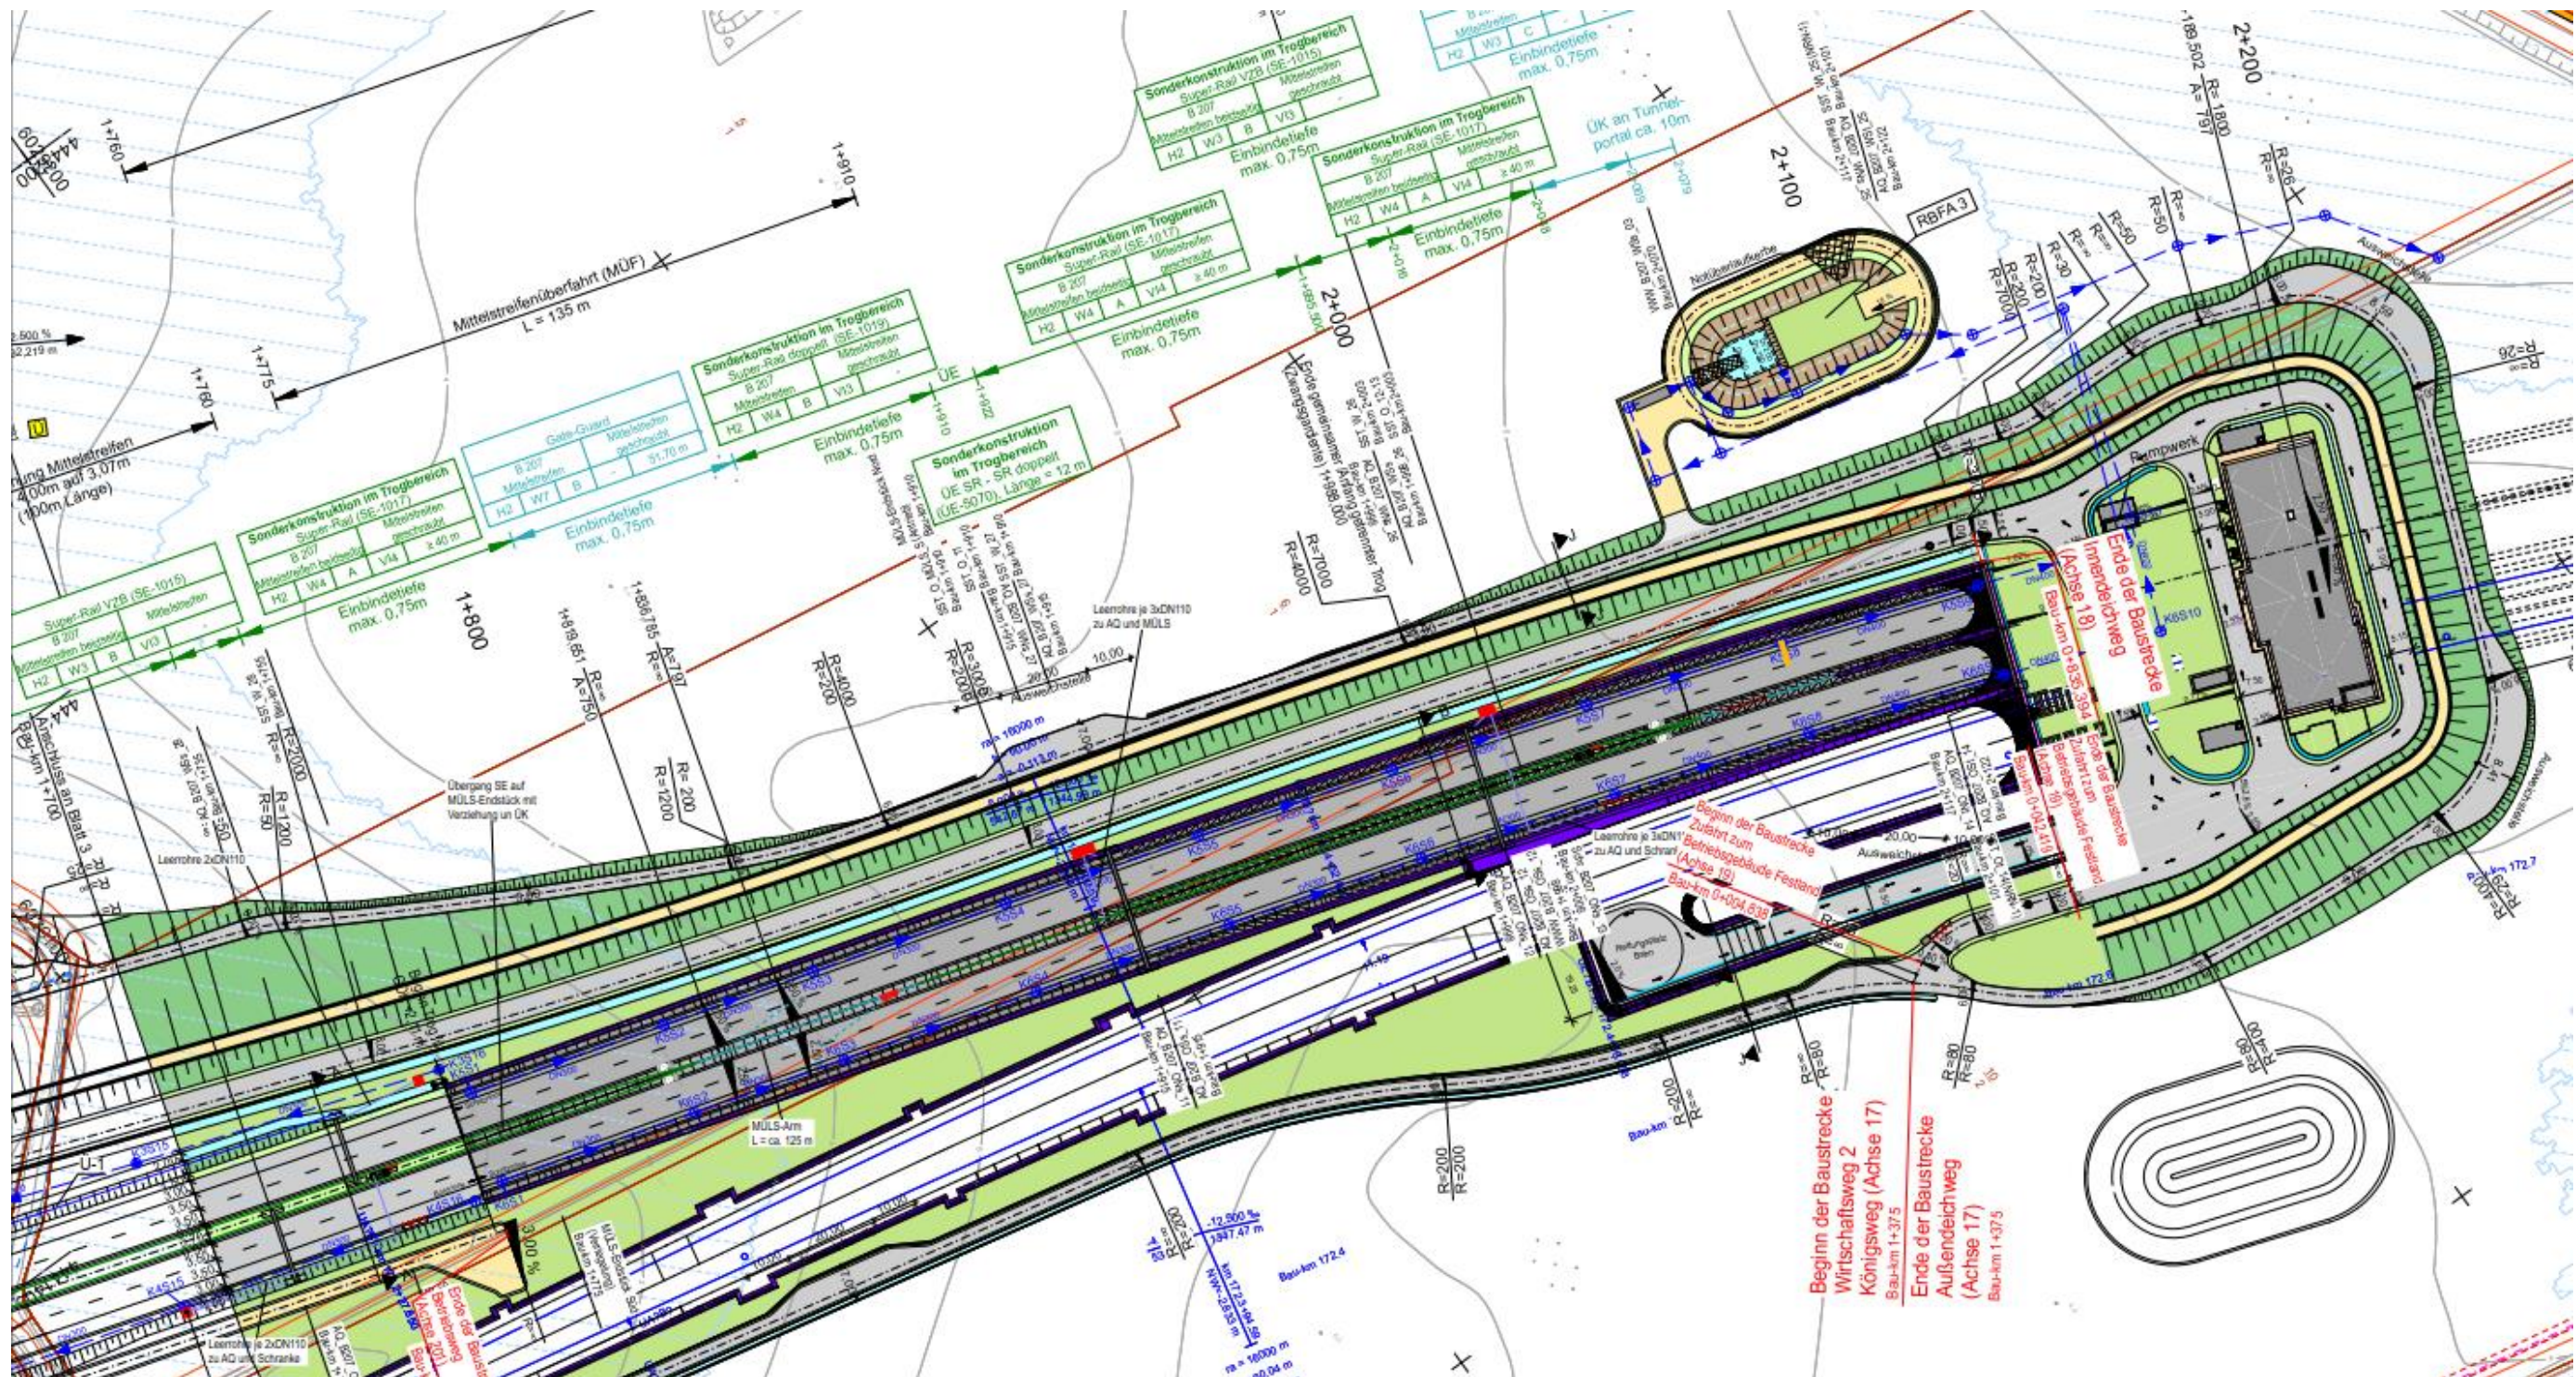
Ausschnitt Lageplan 4.1 Süd Streckenplanung, Stand 13.06.2023 (siehe FBQ_FSQ_0207_99999_VA_2DF_3_P_U05_025503)
